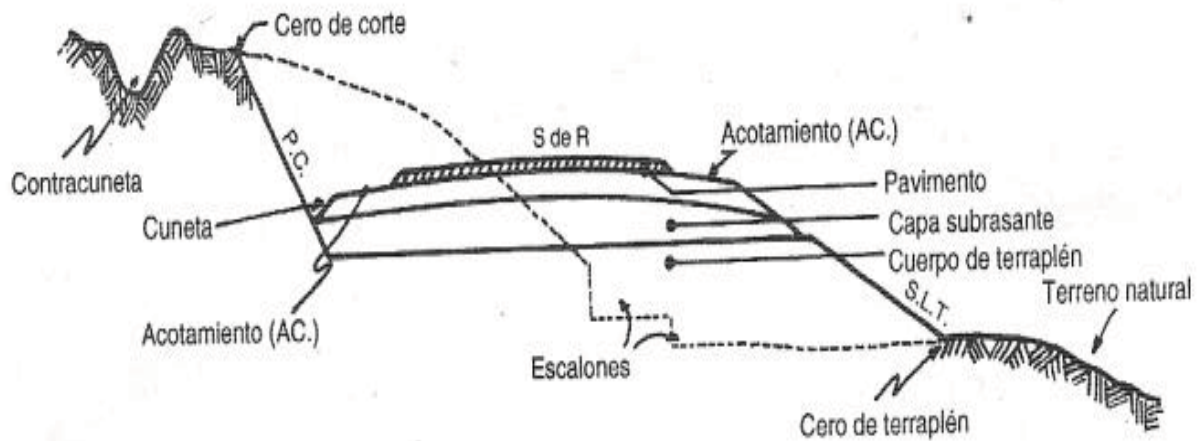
Sección transversal típica mixta o en balcón para caminos de dos carriles.
